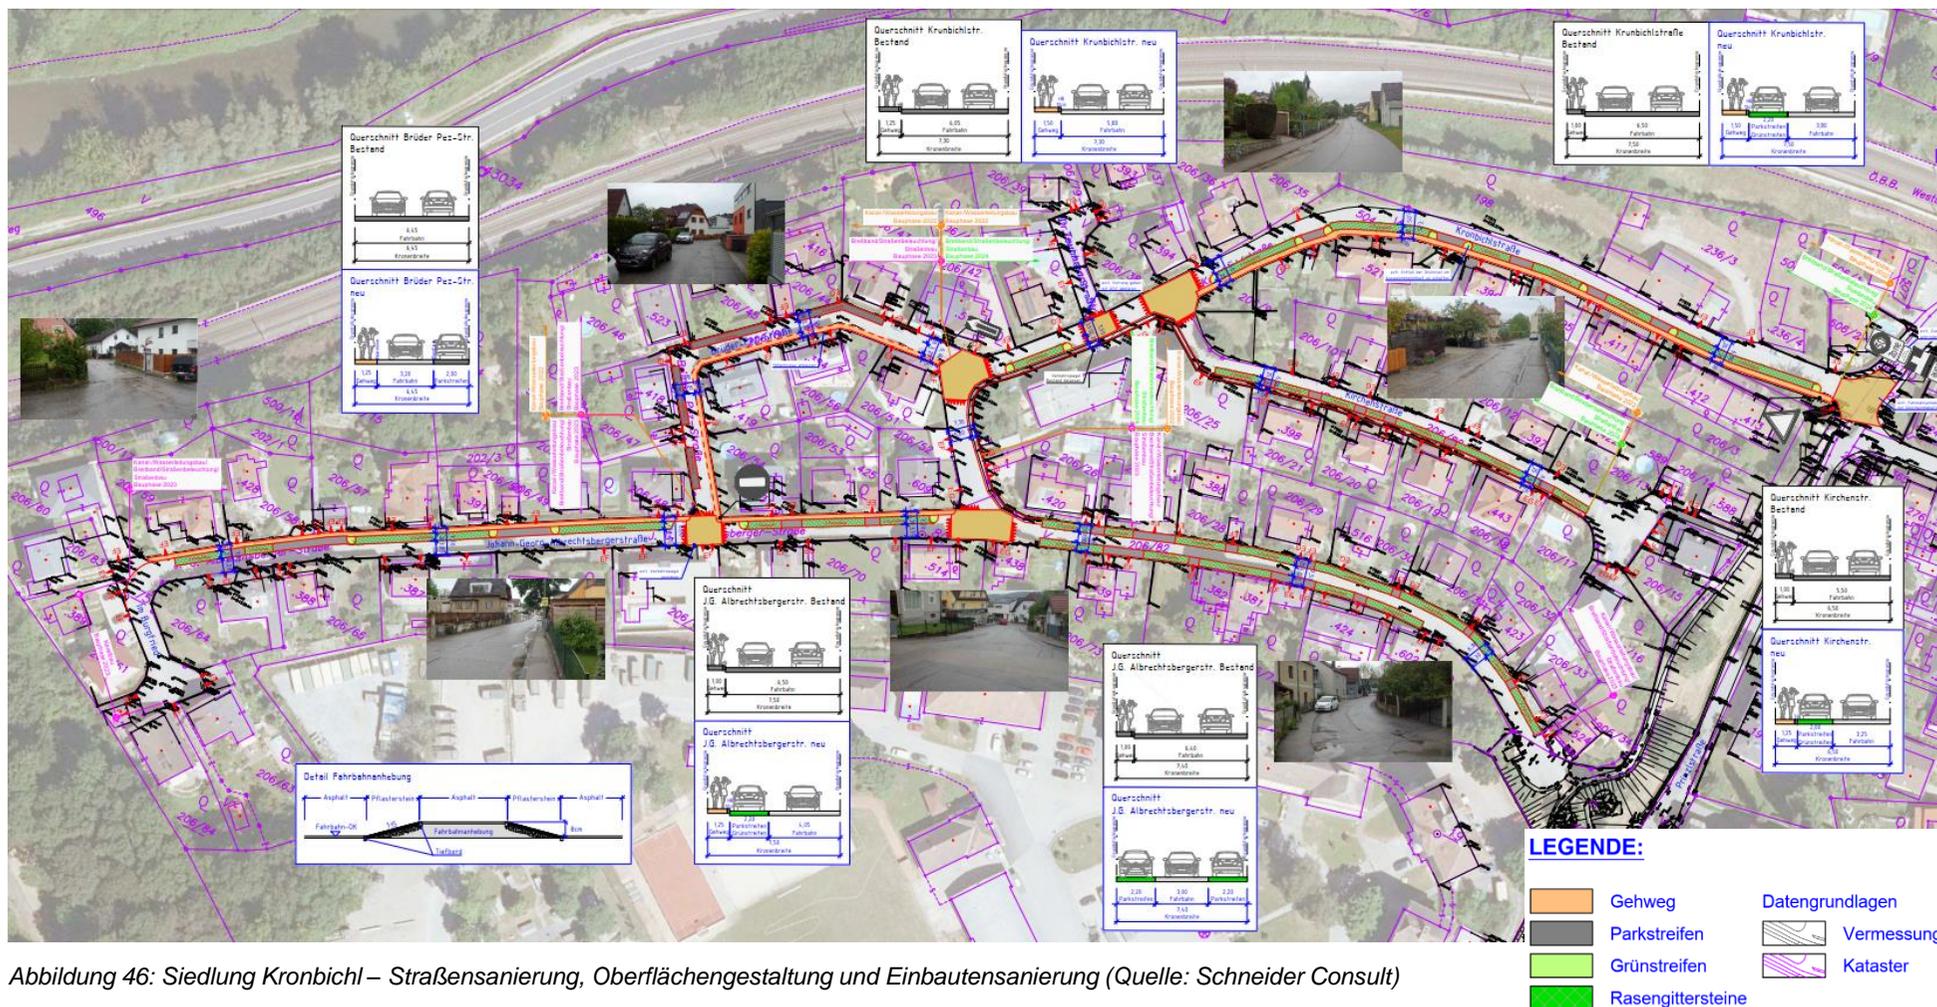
Siedlung Kronbichl – Straßensanierung, Oberflächengestaltung und Einbautensanierung (Quelle: Schneider Consult)
